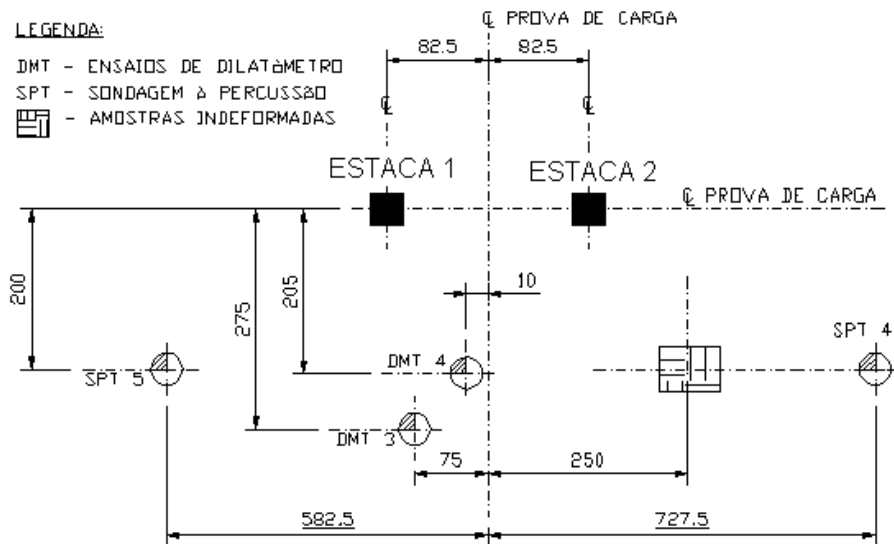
Planta de localização dos ensaios de campo. (Adaptado de GUIMARÃES, 2007)
